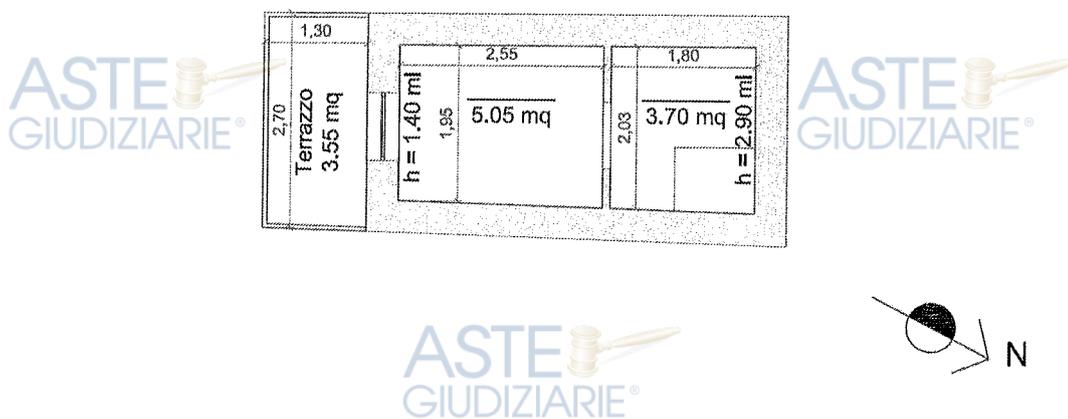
Planimetria Catastale Foglio 47, p.IIa 1393, sub 6 – Piano T-1
